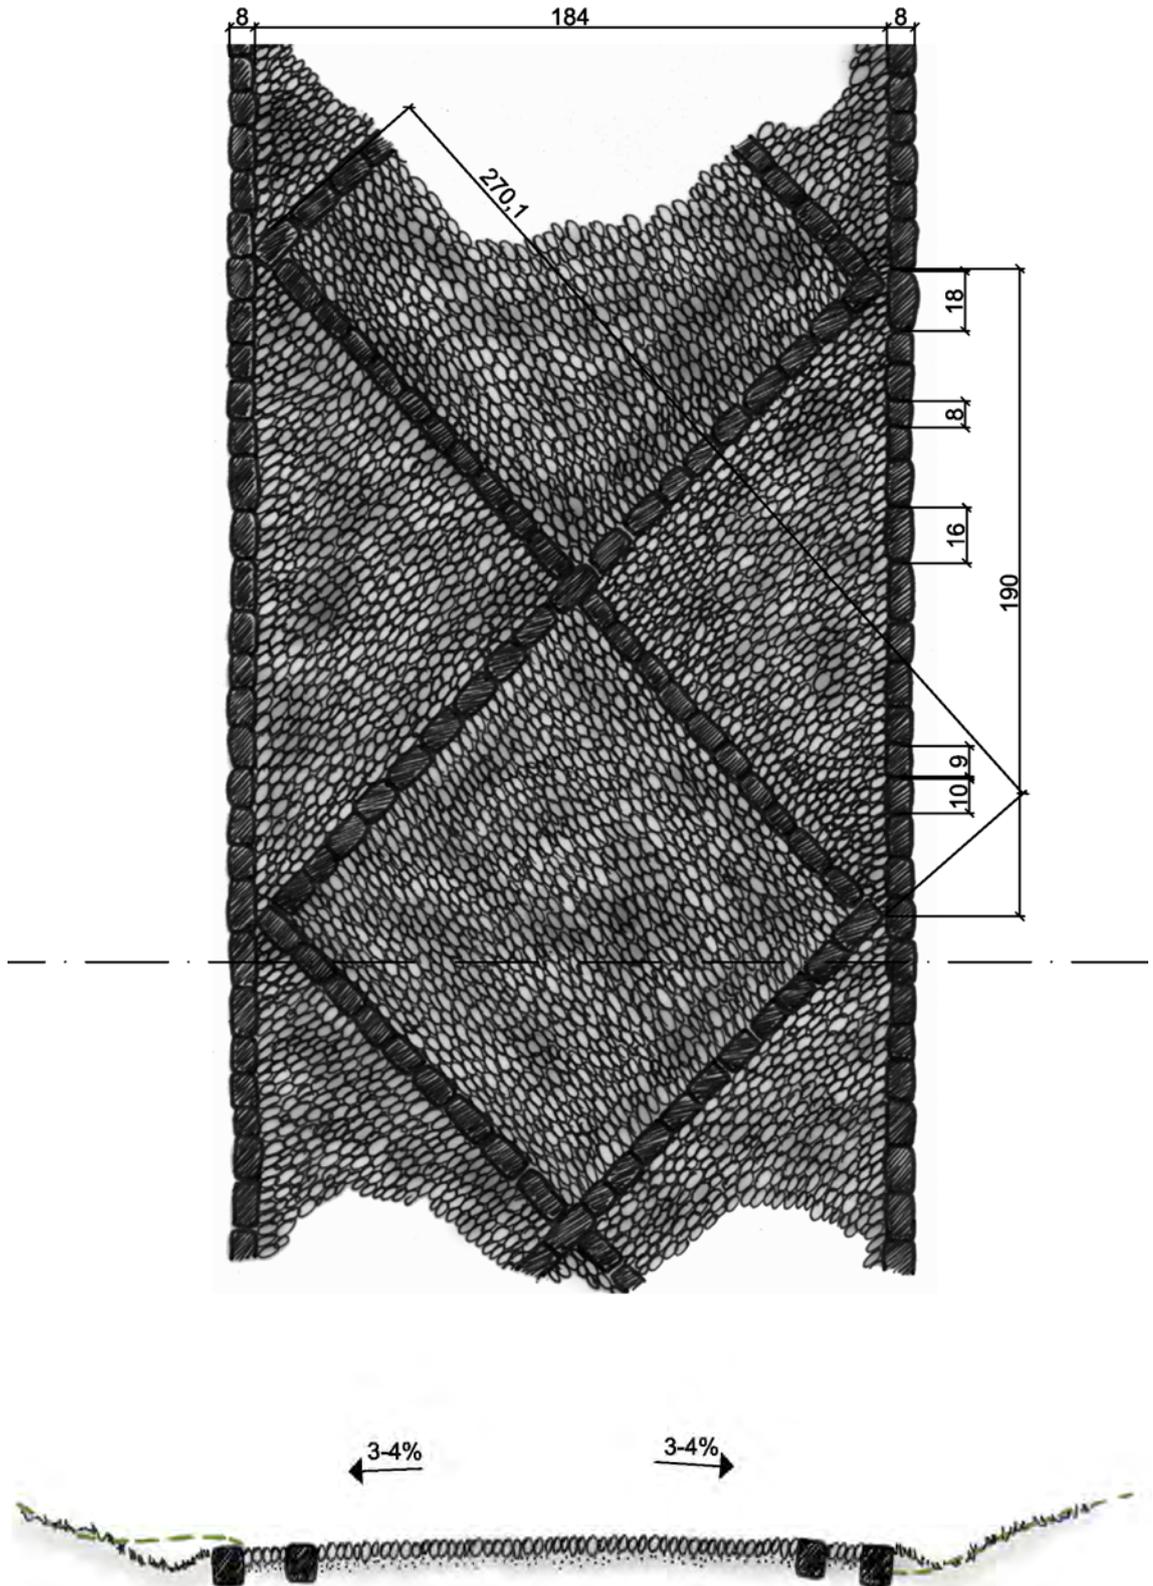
Grundriss und Schnitt Mosaikpflaster Jahngasse (Verlegeplan) mit Geländeanschlüssen Bestand (grün) und wieder herzustellen (scharz) (Drexel, 2011).
